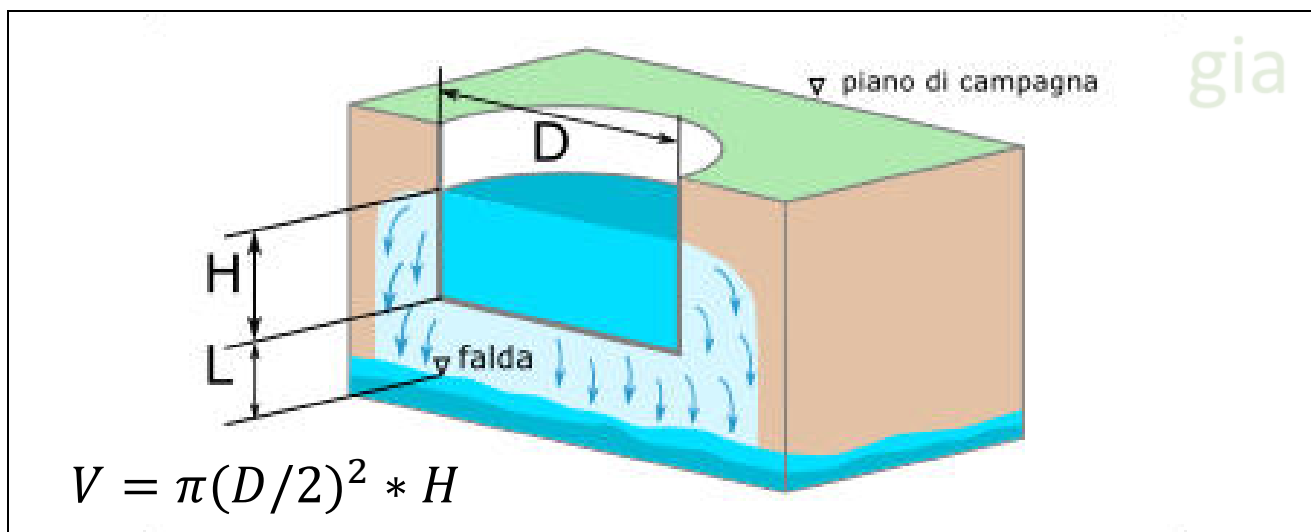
Schema pozzo perdente a sezione cilindrica.
